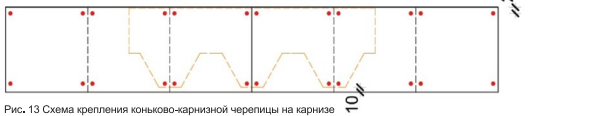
Схема крепления коньково-карнизной черепицы на карнизе
